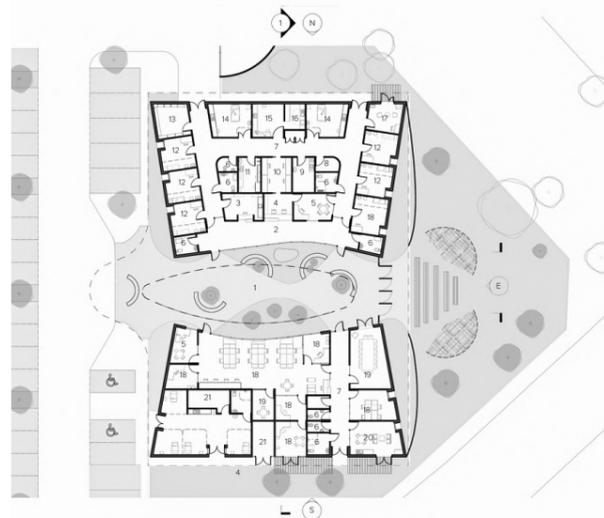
Planta arquitectónica de PAMS. Fuente: Kaulitz Yeung Architecture
